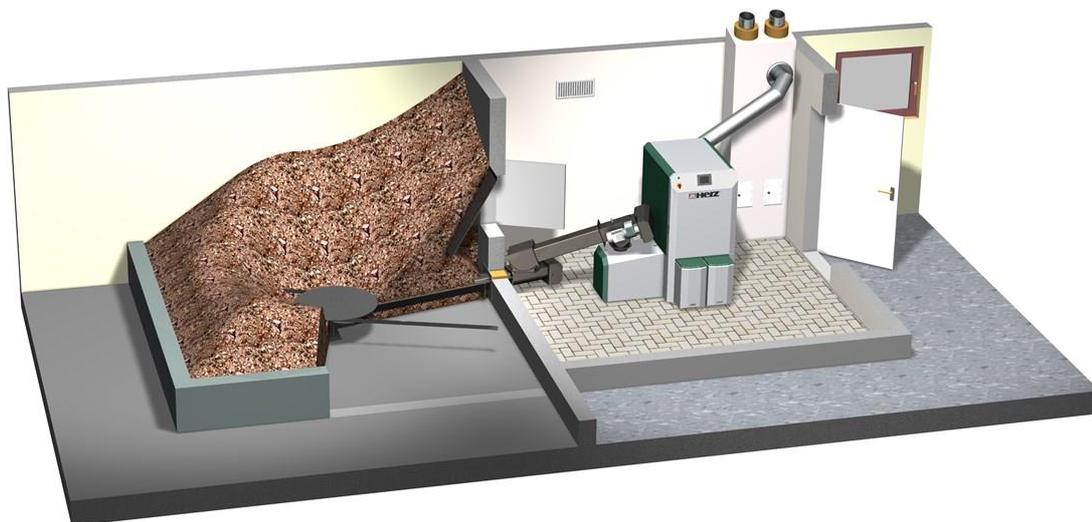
Ensemble silo - dessilleur rotatif - visse sans fin - chaudières (source: SB Thermique)
